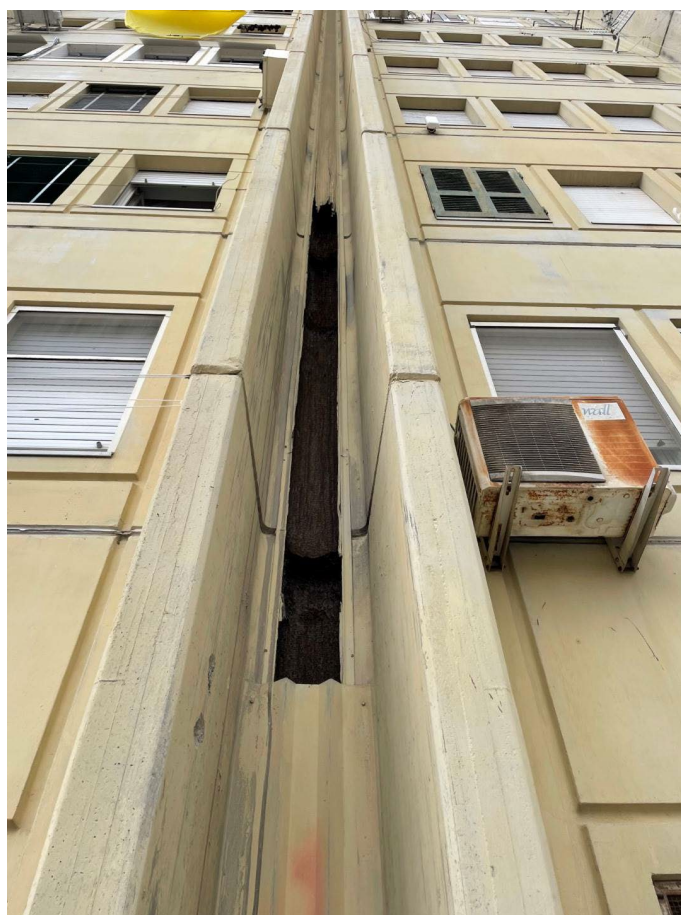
Vista parziale livelli inferiori prospetto principale
